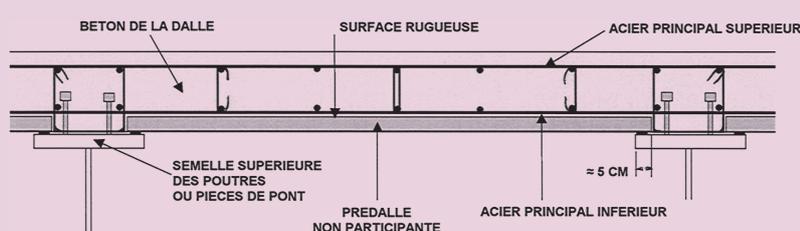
Dalle réalisée avec des prédalles non collaborantes (le ferrailage de la prédalle n'est pas représenté ici)
